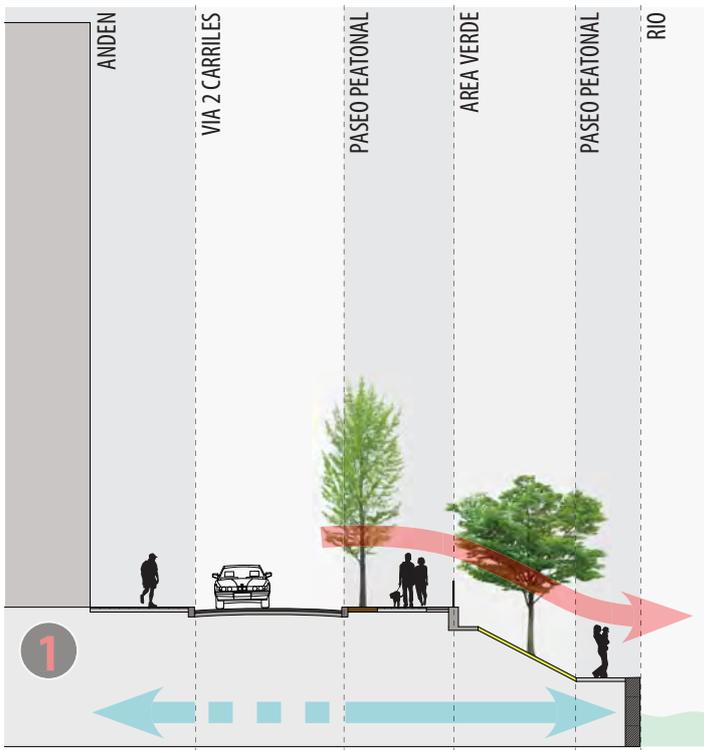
Sección tipo entre Berlin-Friedrichstraße - Marschallbrücke
